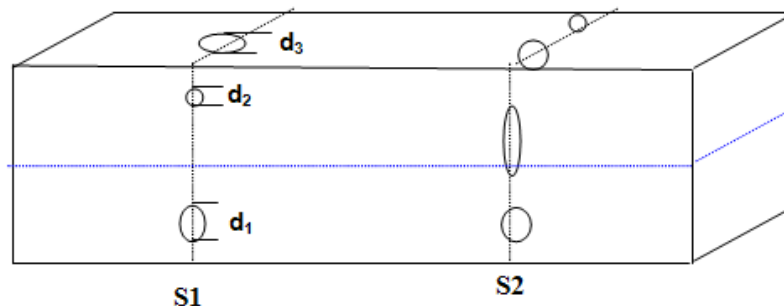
Secciones de defecto para una viga estructural tipo donde existen una serie de nudos.
